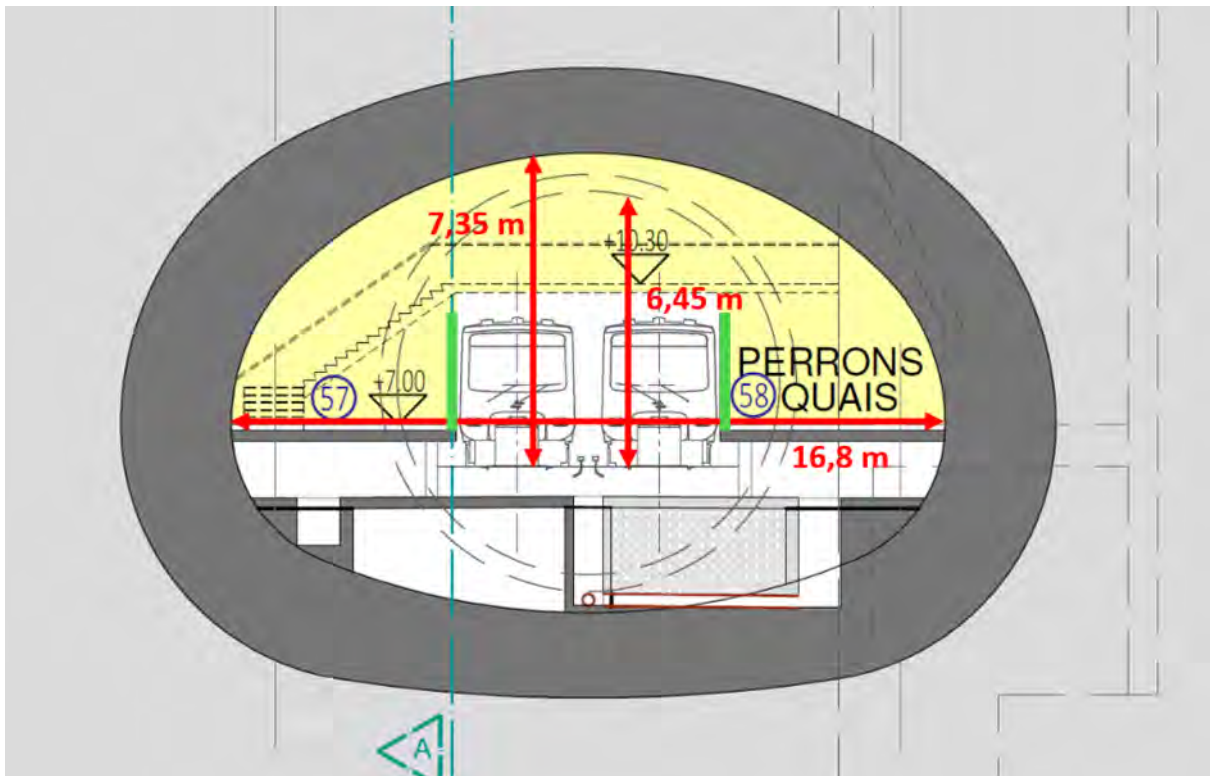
Coupe transversale au niveau des quais – Station Colignon (ARIES, 2020 sur fond BMN, 2018)
